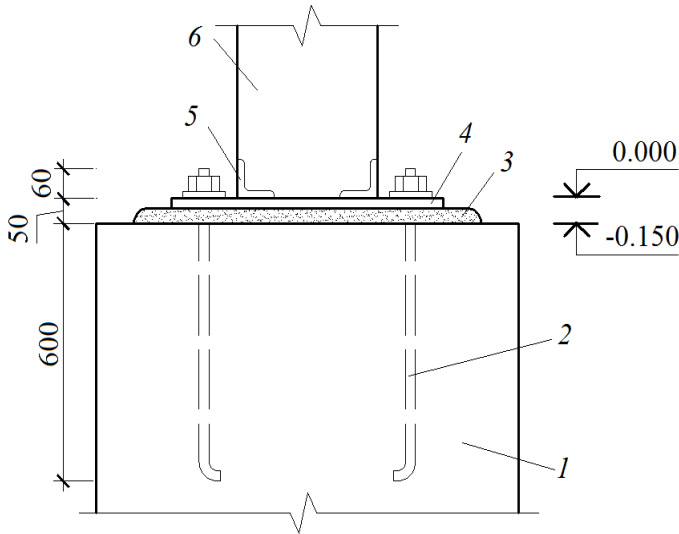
Стовпчасті фундаменти пенькового типу: 1 – монолітний фундамент; 2 – анкерні стержні; 3 – підливка з цементно-піщаного розчину; 4 – опорна пластина (база); 5 – закладні деталі; 6 – залізобетонна фахверкова колона
